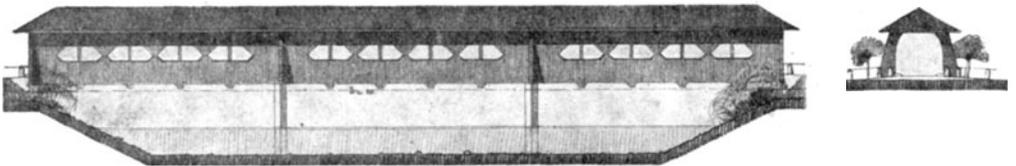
Straßenbrücke mit 3 Öffnungen.
